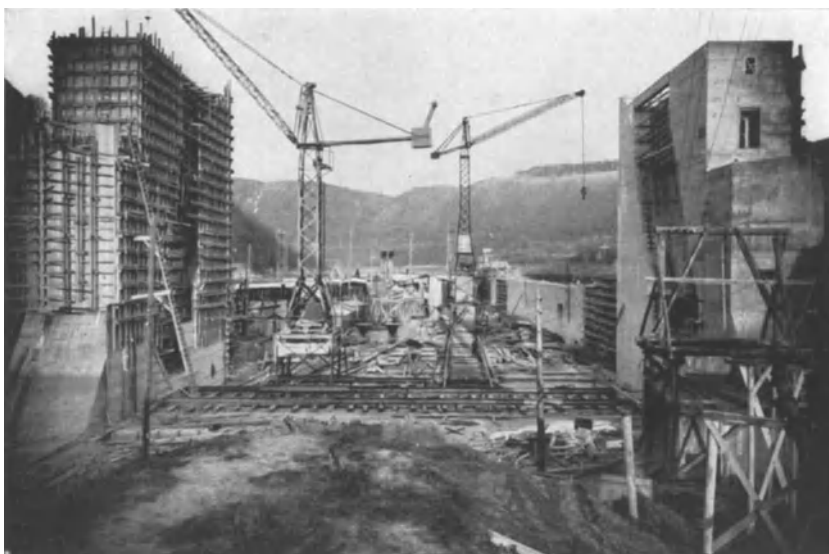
Bau der Staustufe Guttenbach, Transport des Betons in Klappkübeln von $\frac{3}{4}$ cbm Inhalt. Die Pfeiler wurden auf 22 m Höhe geschalt und der Beton mittels eingehängter Hosenröhre, in welcher sich die sichtbaren Kieskübel (auf dem Grunde sind zwei derselben zu sehen) entleerten, eingebracht. Bauausführende Firma: Züblin & Co., Stuttgart.
